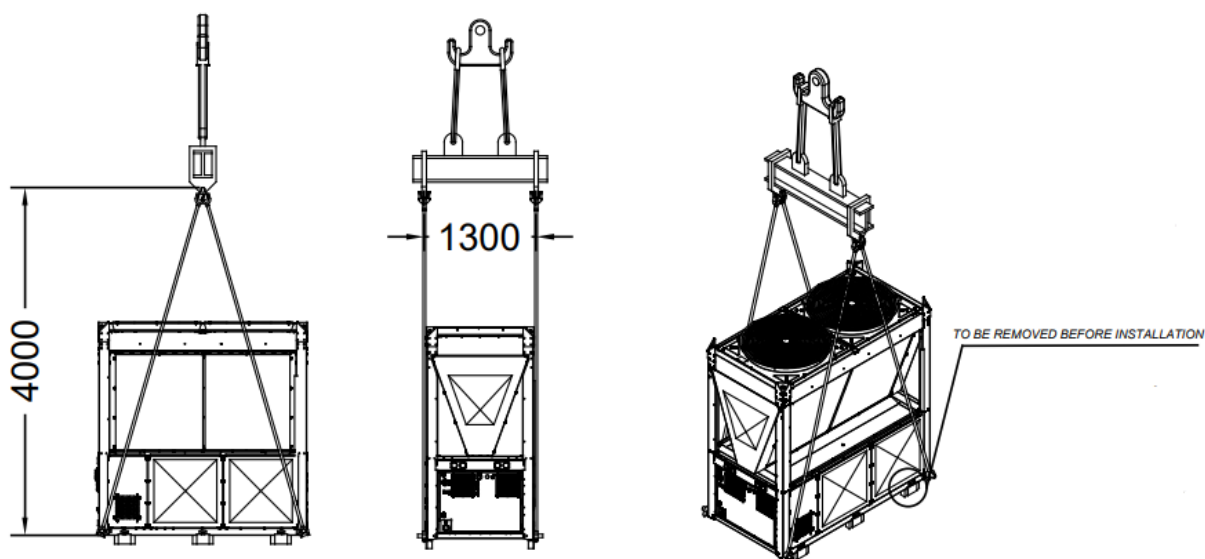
Istruzioni di sollevamento con punti di sollevamento inferiori
